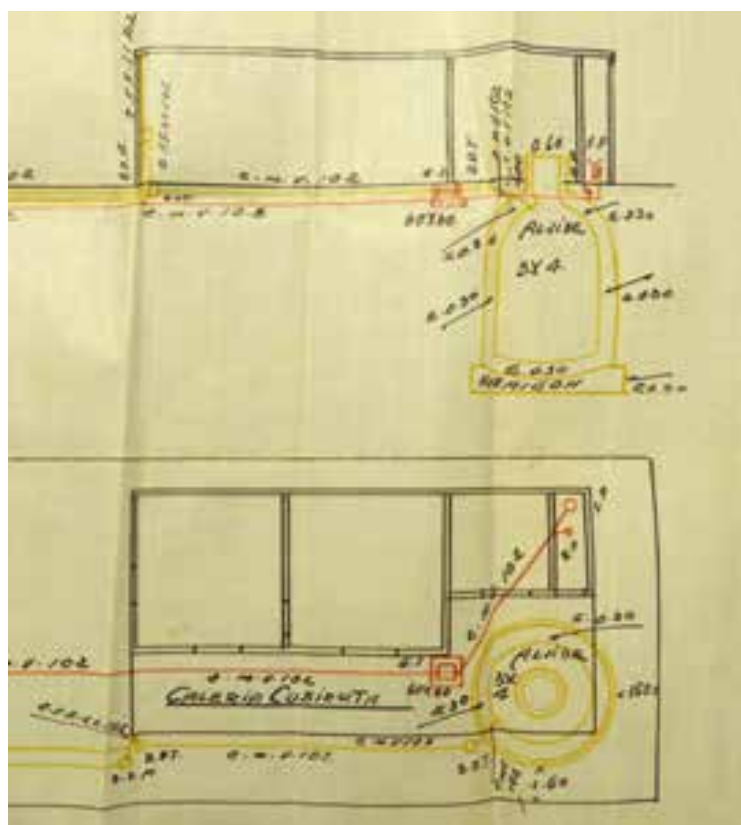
Detalle del plano «Proyecto de obras sanitarias para la propiedad del Sr. José Maroñas» sección y planta de aljibe, 1923
